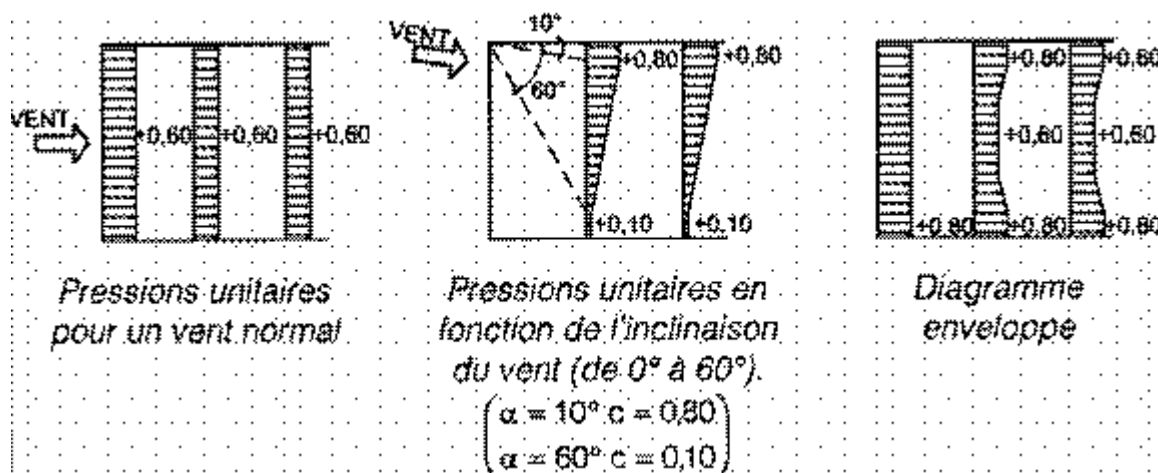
toitures en shed à 30°. Actions du vent sur les zones abritées des parois verticales.
